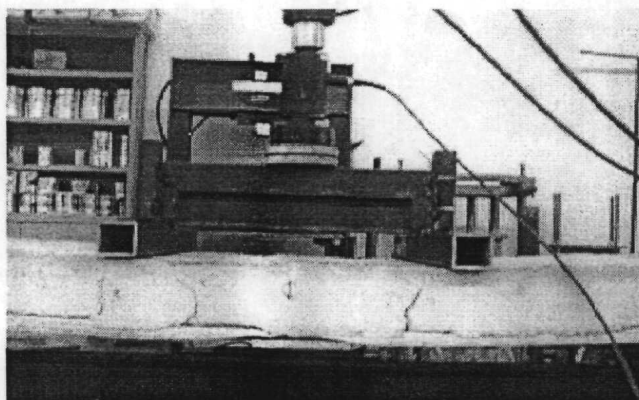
Configuración agrietada de la losa al final de la prueba
